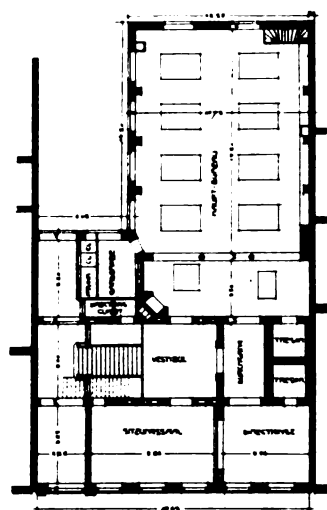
Breitestrasse 8. Erdgeschoss. 1:500.
